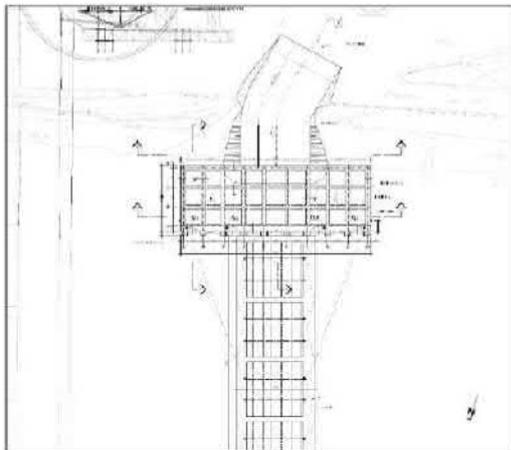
Planimetria generale impalcato pontile SP1 Sicilia (el.CZ0256_F0)
